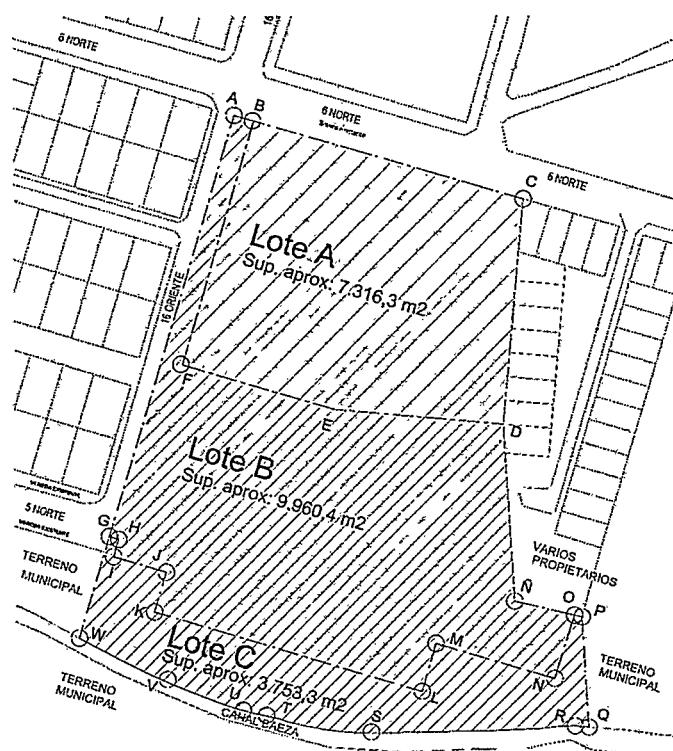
Plano de Subdivisión sobre Terreno Serviu Etapa 1 Proyecto Barrio Parque Cornelio Baeza, Comuna de Talca.
